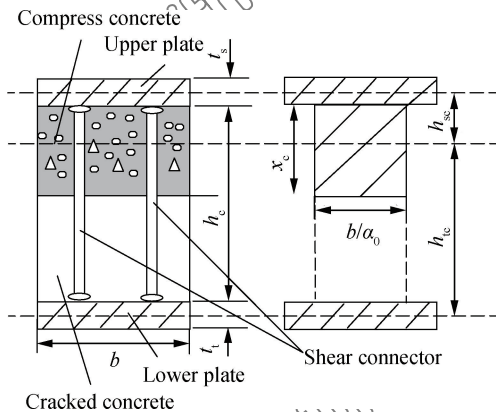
钢板夹芯混凝土组合梁截面形式及等效截面
